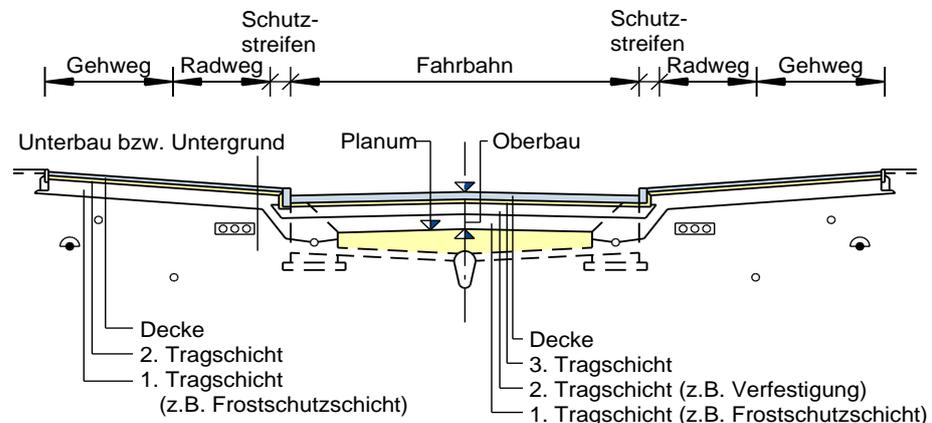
In geschlossener Ortslage mit teilweise wasserundurchlässigen Randbereichen sowie mit Entwässerungseinrichtungen
